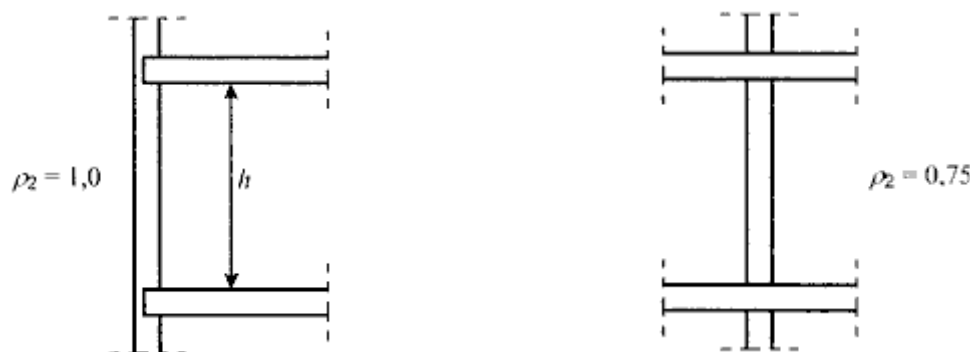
Жесткое защемление перекрытиями и конструкциями крыши
